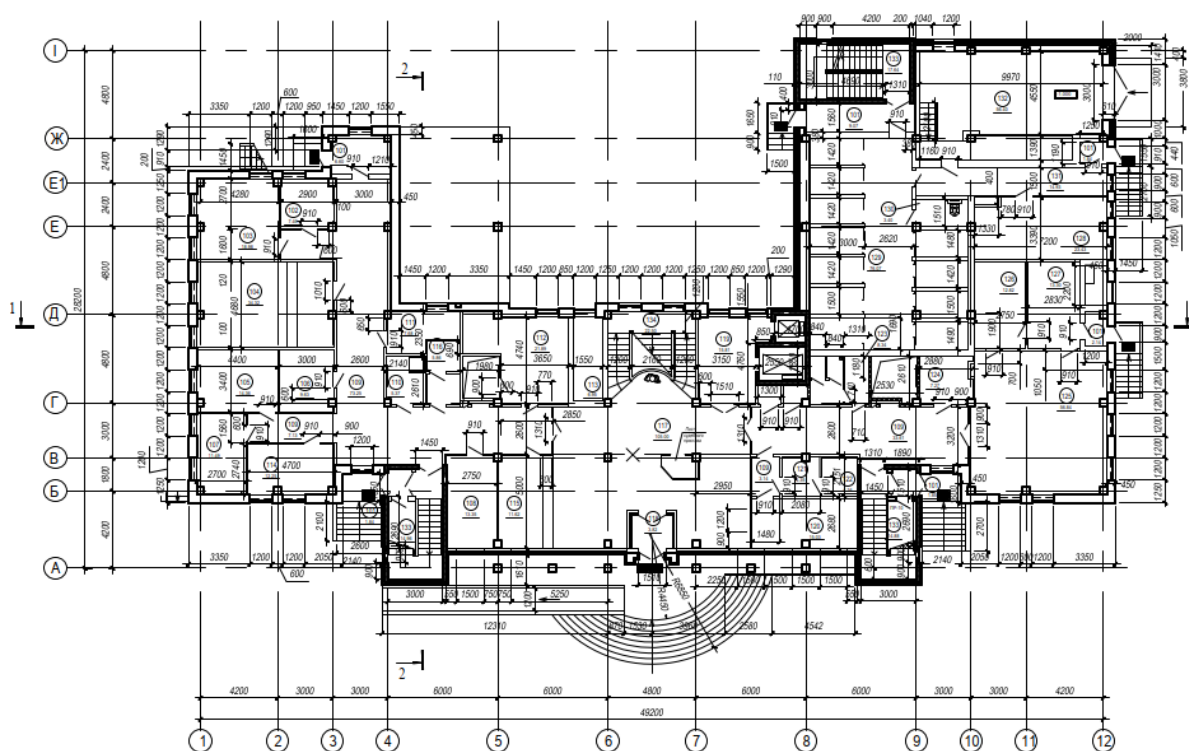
План будівлі на відмітці 0,000 (перший поверх)
